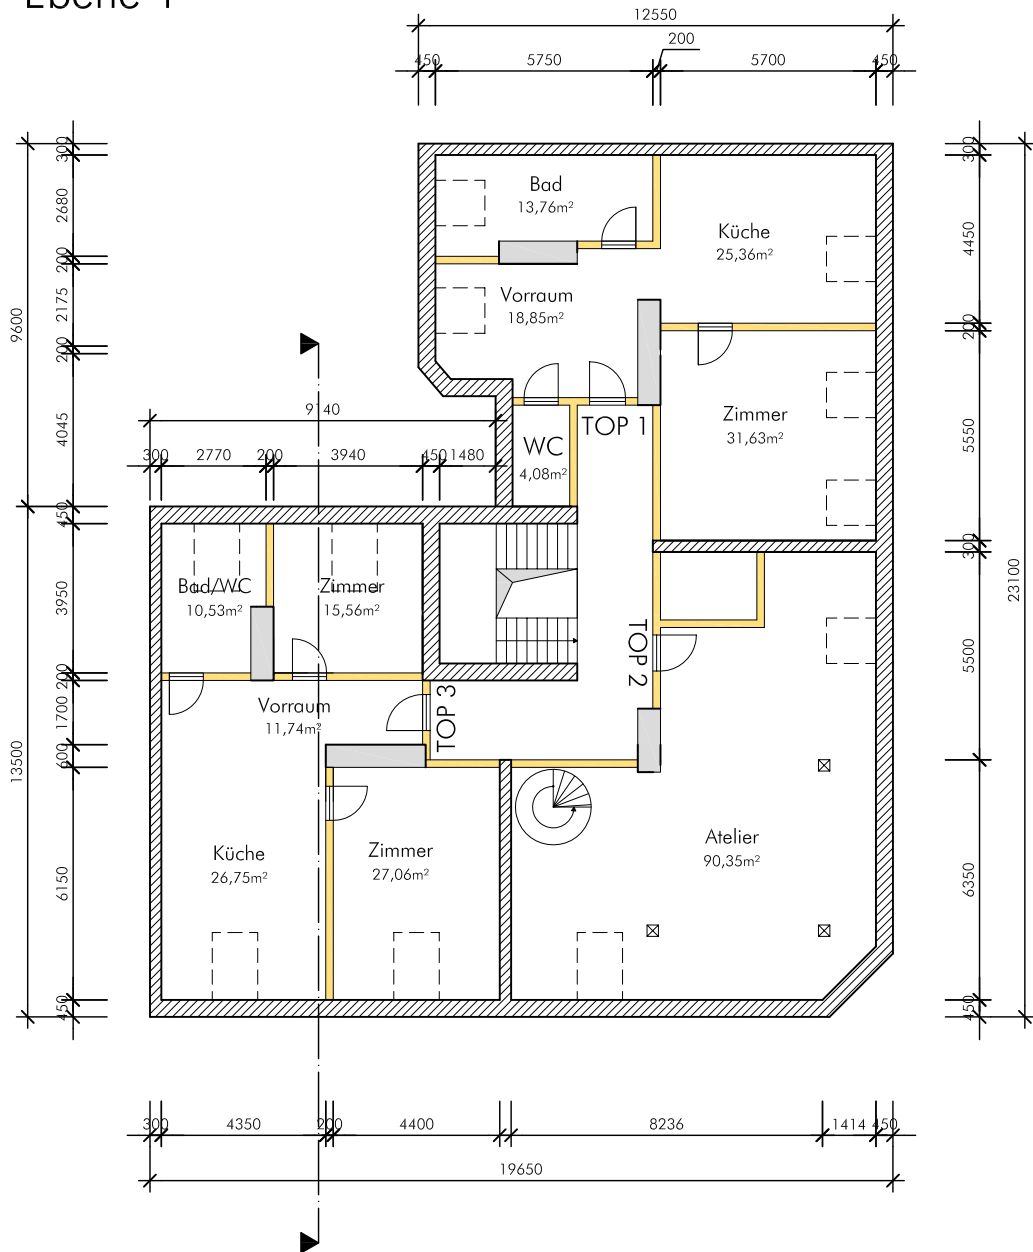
Grundriss Dachgeschoss Ebene 1 M 1:200 (Maße in mm)
